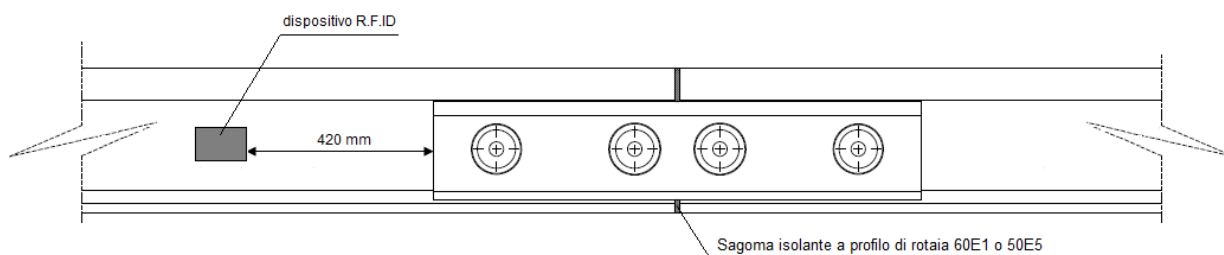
vista longitudinale della GII dell'armamento 60E1 / 50E5
